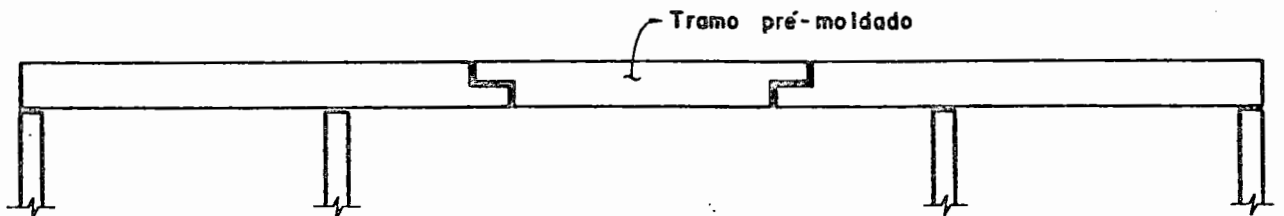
ILUSTRAÇÃO DE POSSIBILIDADE CONSTRUTIVA DE PONTE EM VIGAS GERBER
